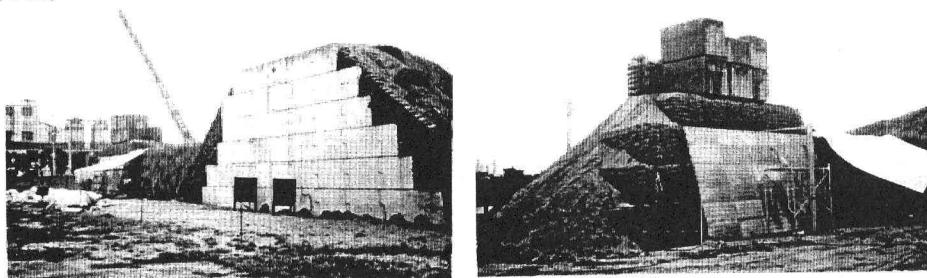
法面コンクリートブロックを使用したポリマーグリッド補強土擁壁の完成状況
